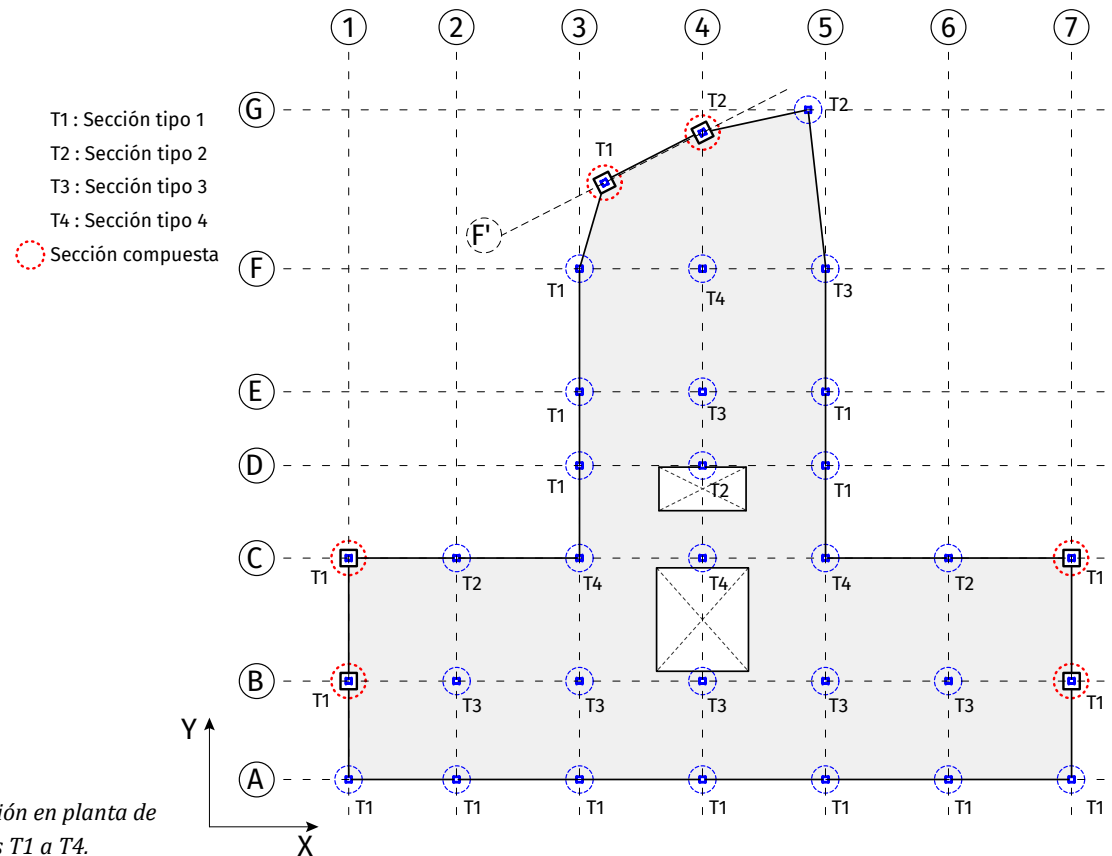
Ubicación en planta de secciones armadas T1 a T4.
